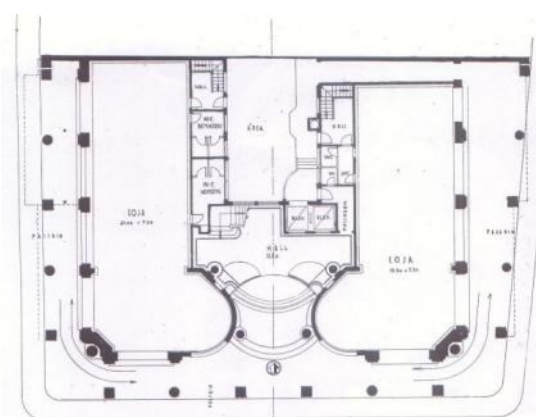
Planta Baixa do pavimento térreo do edifício IPASE. Fonte: O Construtor, N° 59, jan-fev, 1944. In: TEIXEIRA, 2009.
